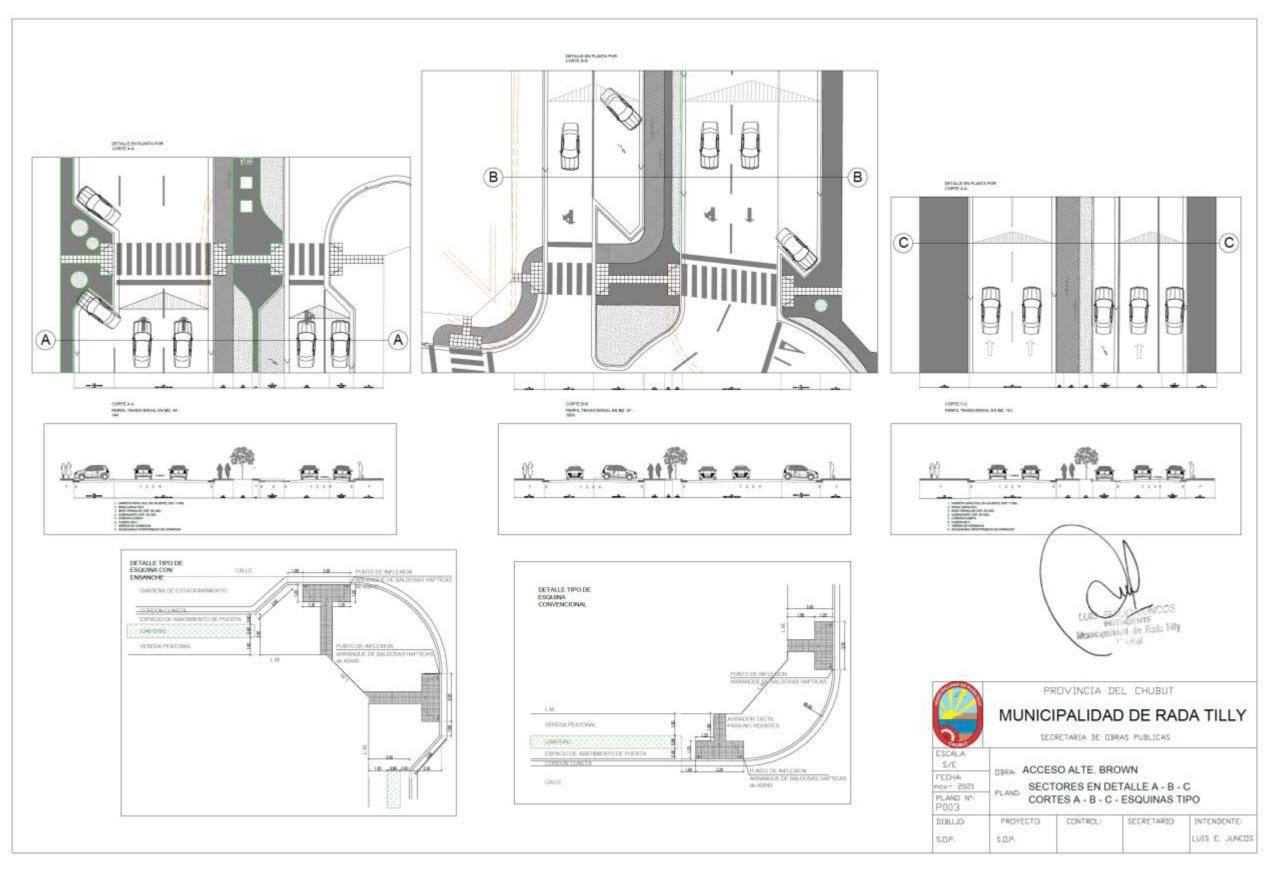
Plano con detalle de cortes (A-B-C) del Proyecto. Fuente: Municipalidad de Rada Tilly.
